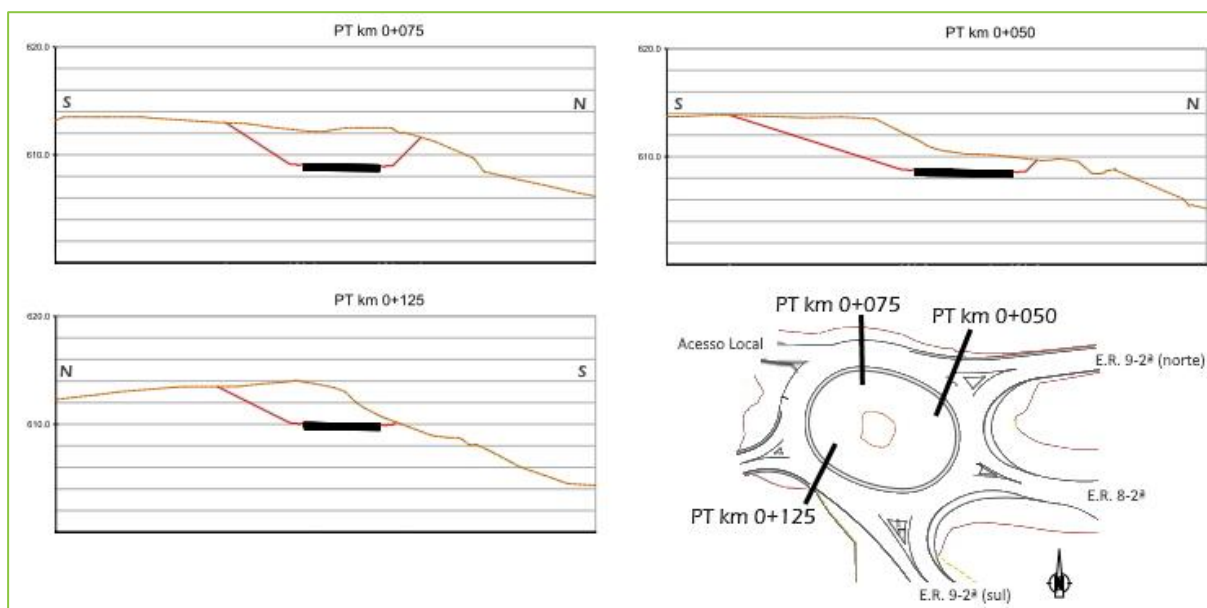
| Perfis topográficos esquemáticos de setores da rotunda na situação de referência (perfil a castanho) e após a obra (perfil a vermelho) (dados do projeto)
